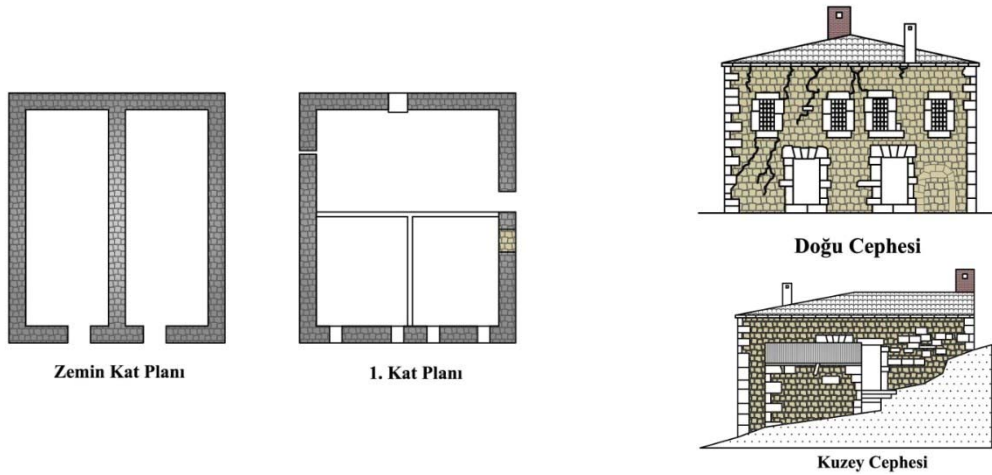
Piştöflu Mahallesi Kilise Plan ve Cepheleri
